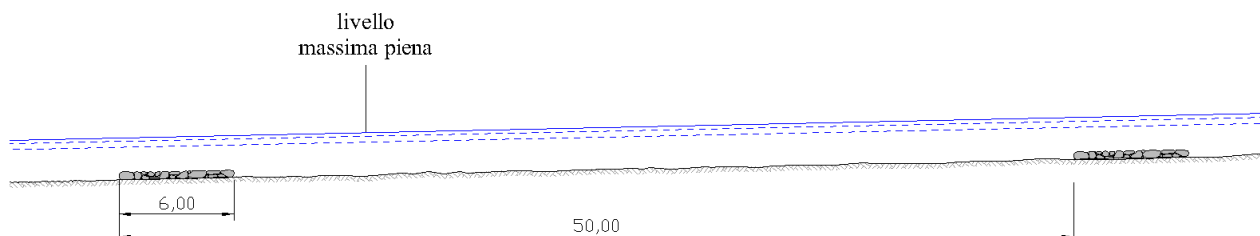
SEZIONI: STRALCIO DELLA TAVOLA D5 - REALIZZAZIONE DI PLATEE DI DISSIPAZIONE IN PIETrame SCAPOLO - PLANIMETRIA - AREA 10 – SEZIONI, ALLEGATA AL PROGETTO DEFINITIVO 2012
